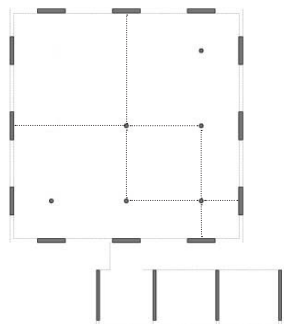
Estructura mixta de muros pantalla y pilares, nivel 1. Fuente: MCHS.
